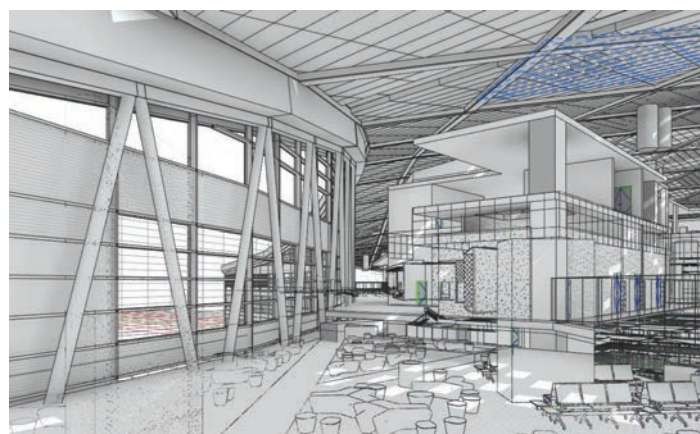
Stralcio modellazione 3D architettonica vista interna facciate in ambiente BIM
